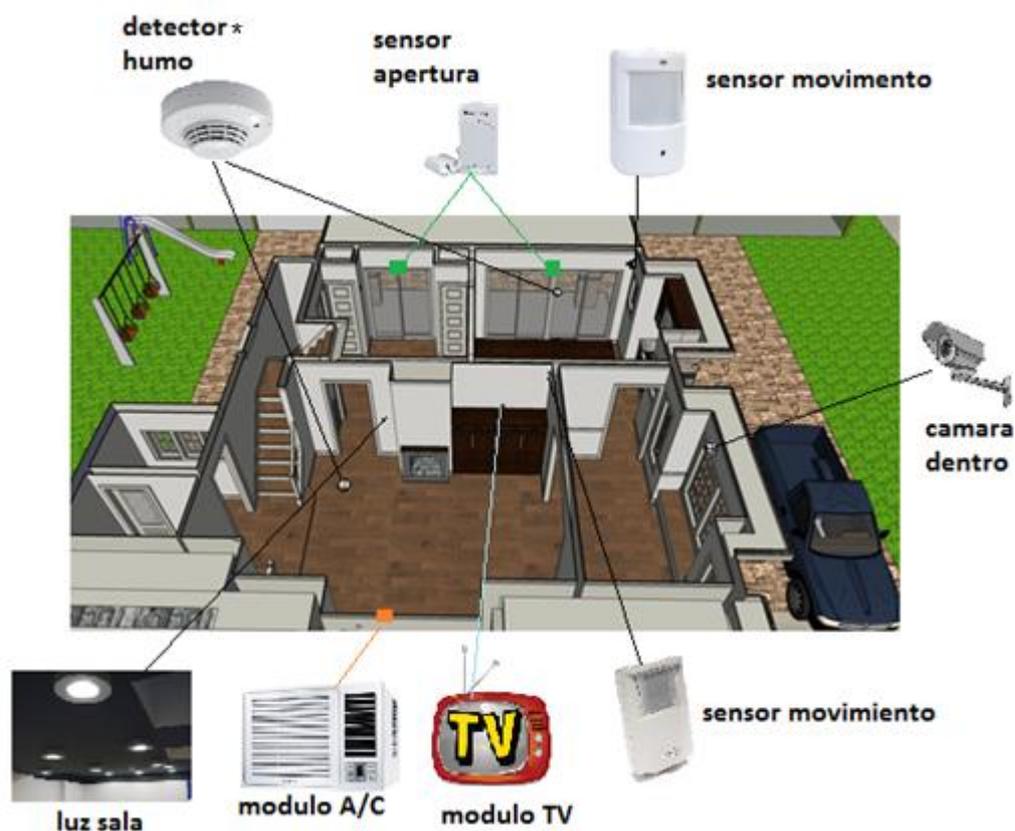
Parte Seccionada Planta Baja. (\*En el tumbado)
